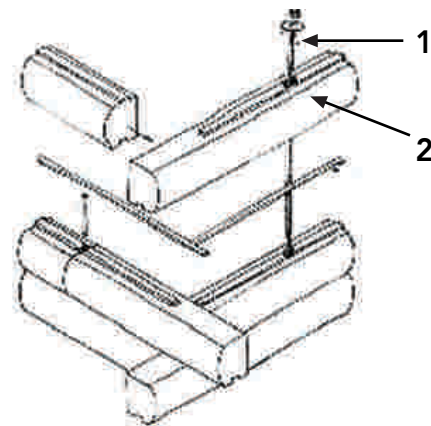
B. Cada tronco se va colocando uno sobre otro, amarrados en su interior con fierros verticales de diámetro de 8 mm (1) y sellando longitudinalmente el encuentro entre estos con espuma de poliuretano (2), como protección a la infiltración de aire y lluvia del exterior y salida de calor del interior.
